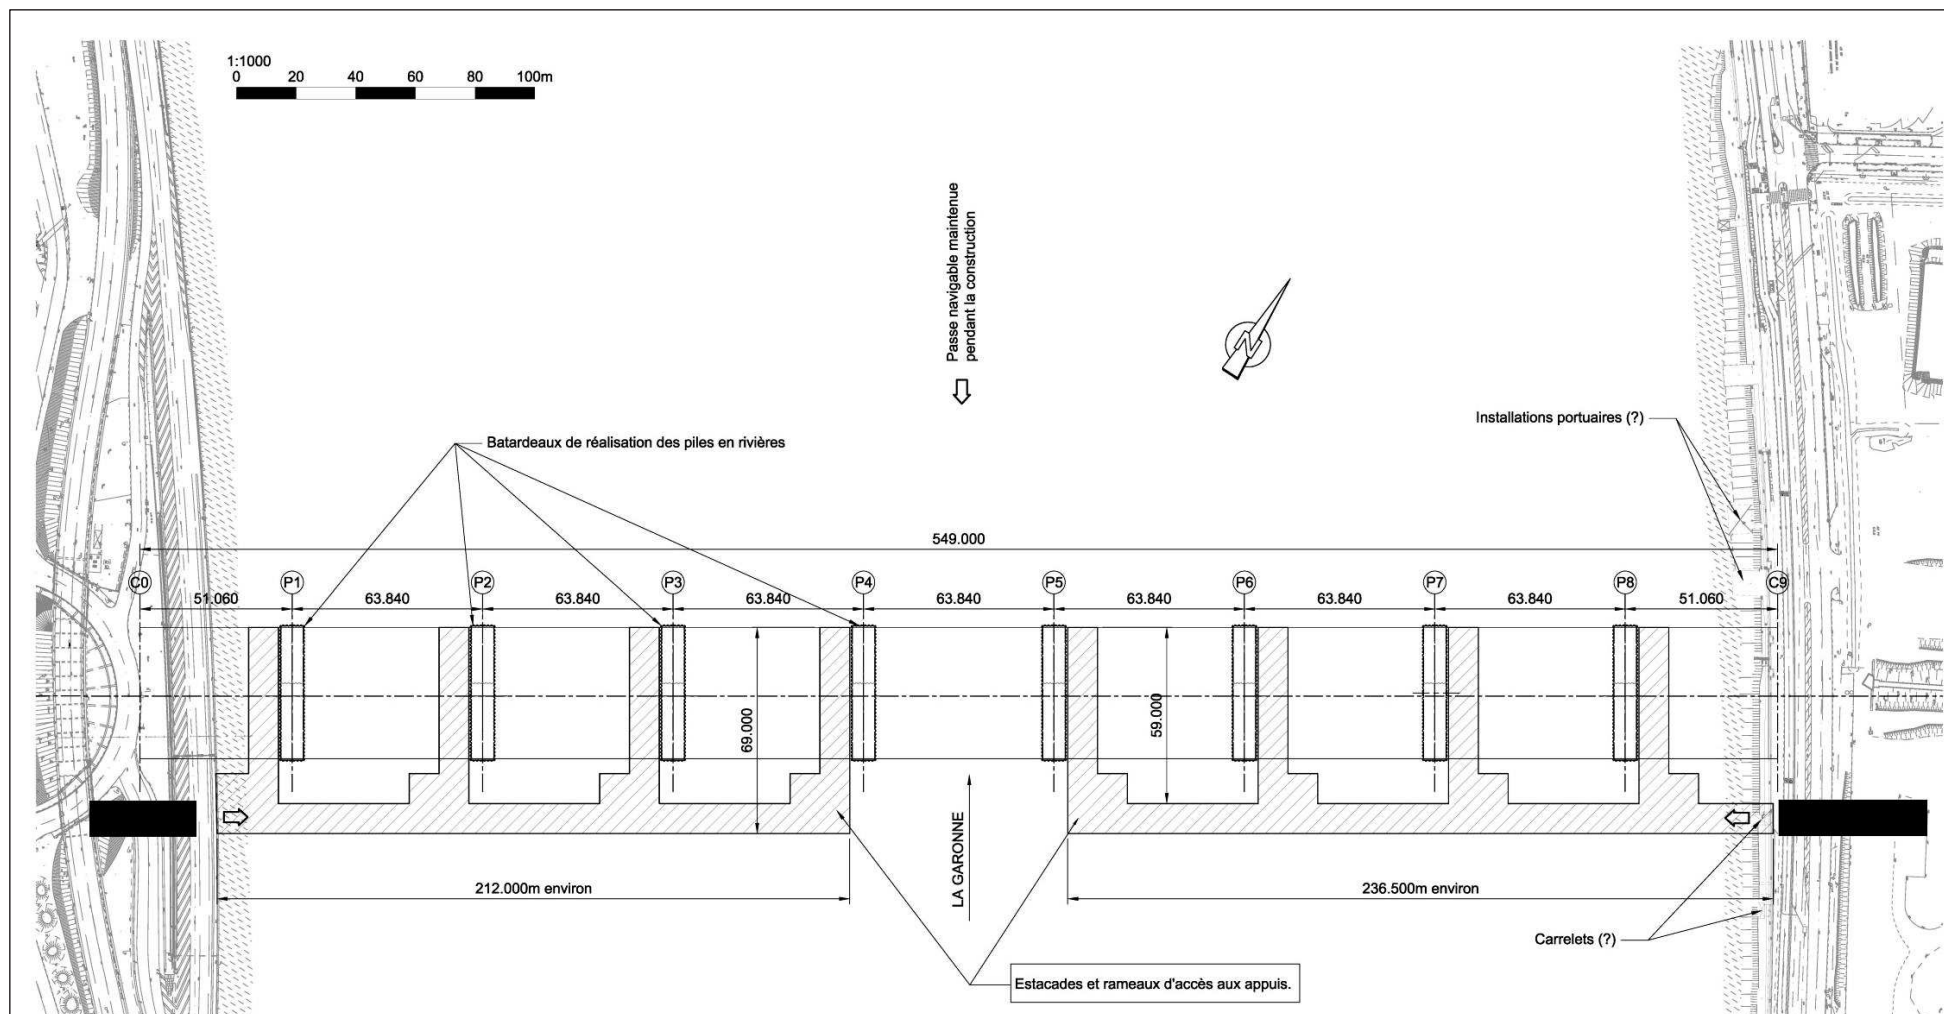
Vue en plan des estacades provisoires ; exemple de configuration envisageable : passe navigable entre les piles P4 et P5
